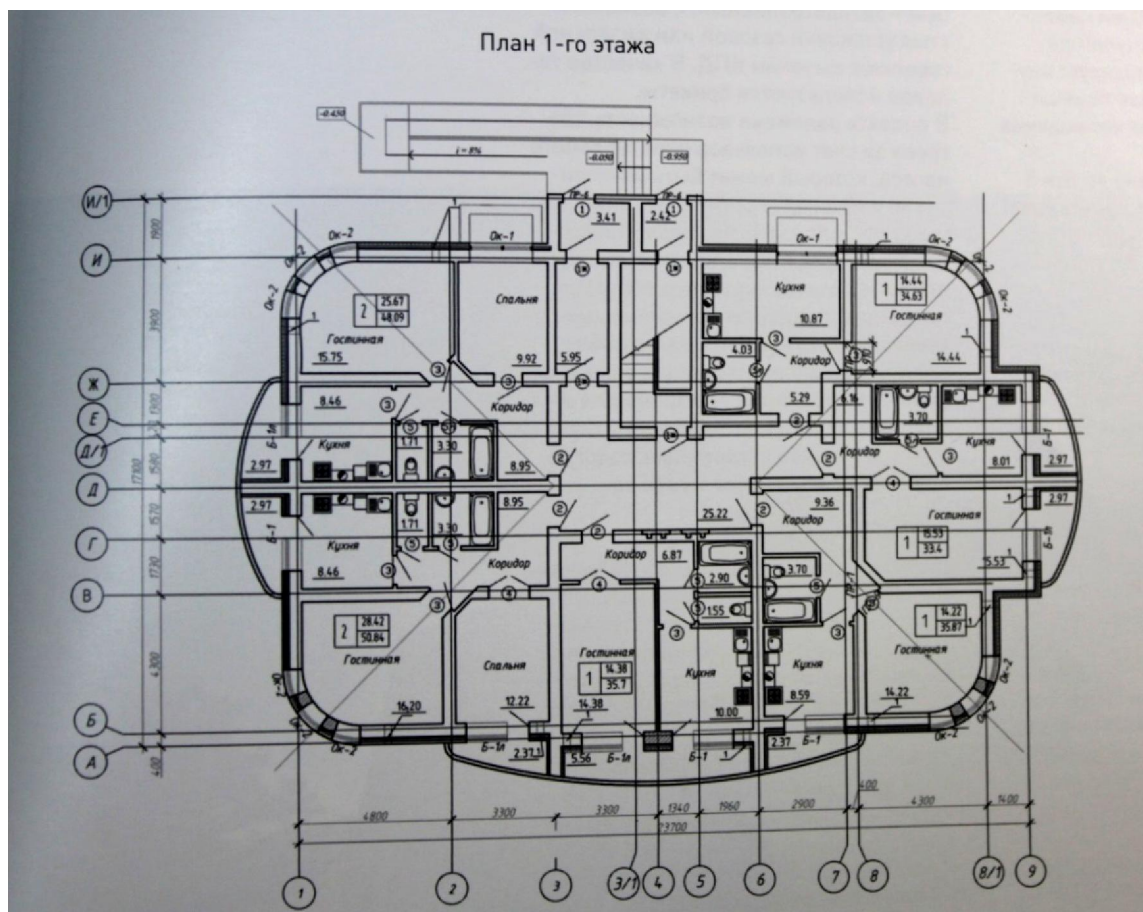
План 1-ого этажа 12-квартирного двухэтажного дома
